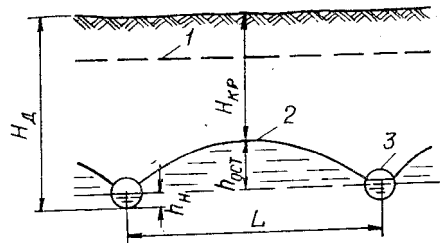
Схема понижения уровня грунтовых вод горизонтальным дренажом: 1,2 - уровень грунтовых вод соответственно до и после строительства дренажа; 3 - горизонтальные дрены; H_d - глубина заложения дренажа; $H_{кр}$ - критическая глубина залегания грунтовых вод; $h_{ост}$ - остаточная глубина залегания грунтовых вод; h_n - глубина наполнения дрены
